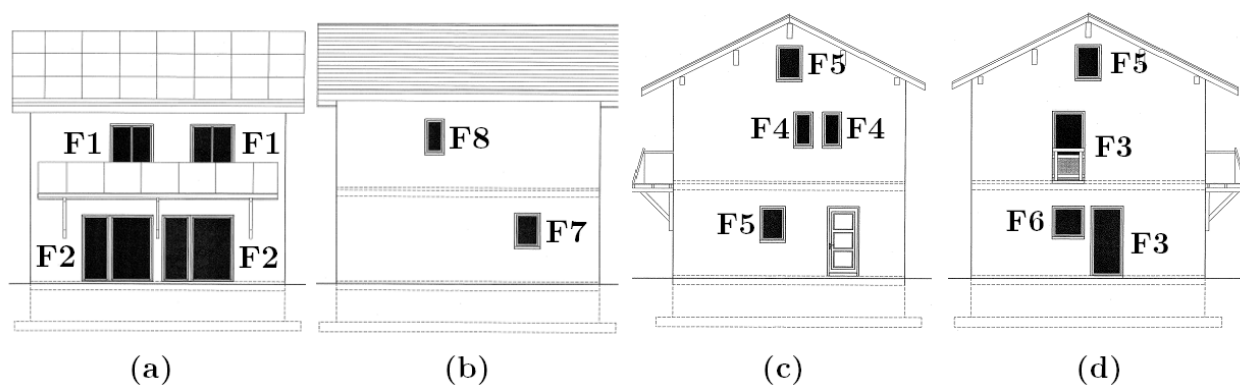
Plan des façades la maison I-BB, (a) sud, (b) nord, (c) ouest, (d) est. Source (Munaretto, 2014)
